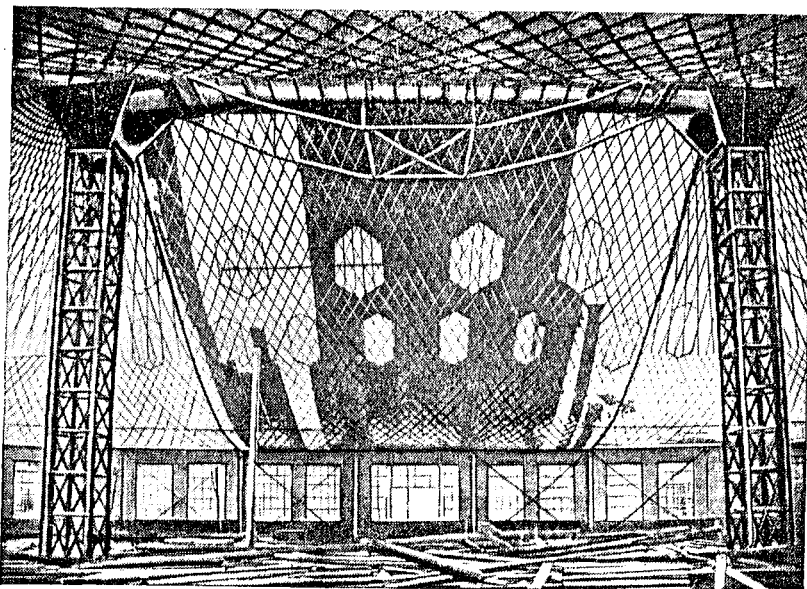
Šuchovsches Hängedach über einem Gebäude, das im Grundriß die Form einer Ellipse hat.
